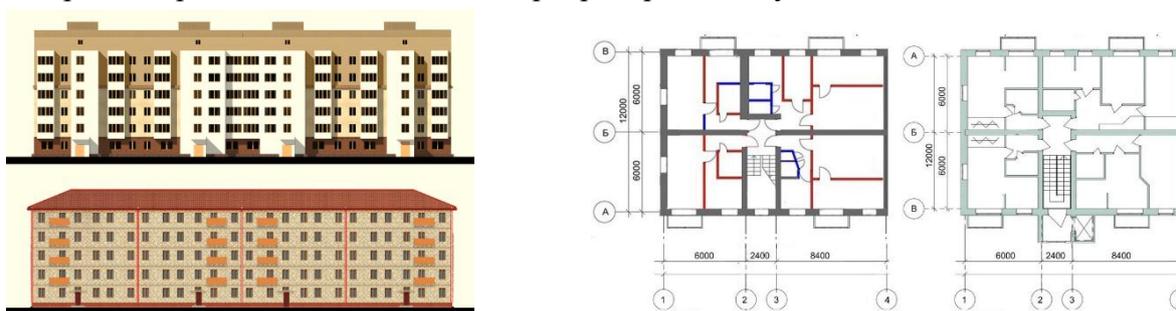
Фасад и сечения д.№8 до и после реконструкции
